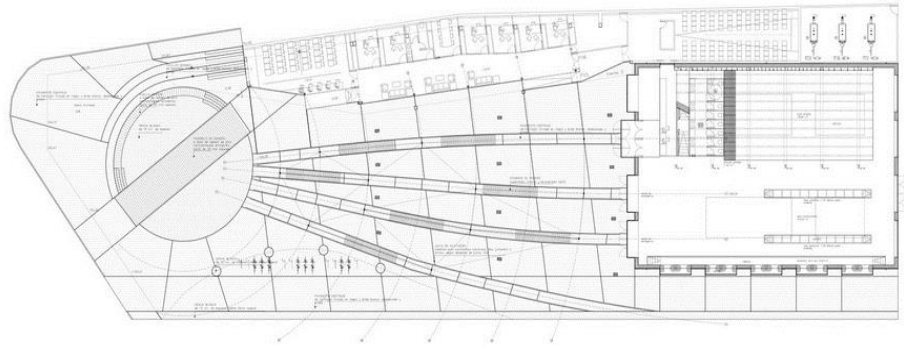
Planta del centro urbano ferroviario de León - España.
